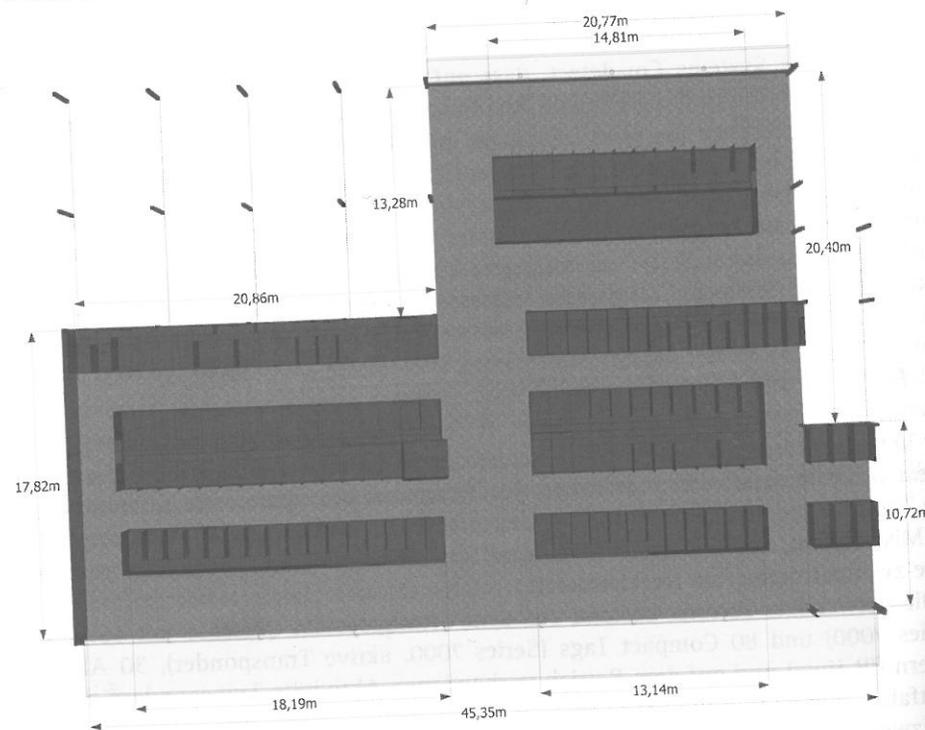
Grundriss des Versuchsstalls (Erfassungsbereich grau hinterlegt)
